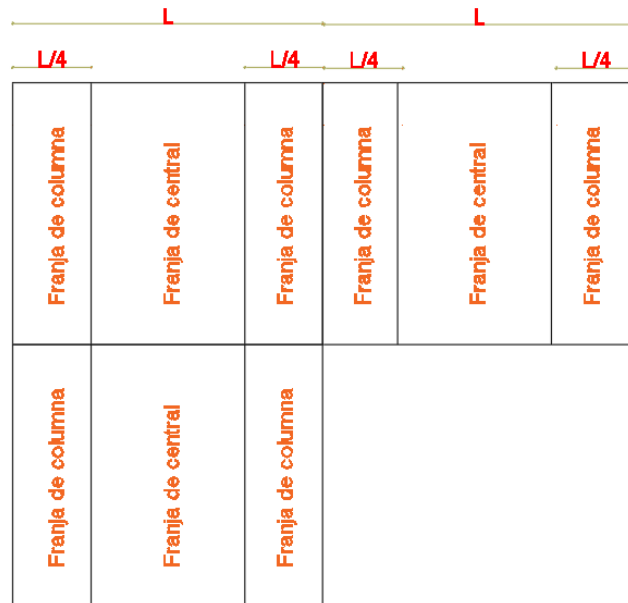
Franja central y franja de columna en paños de losa (sentido Y)
